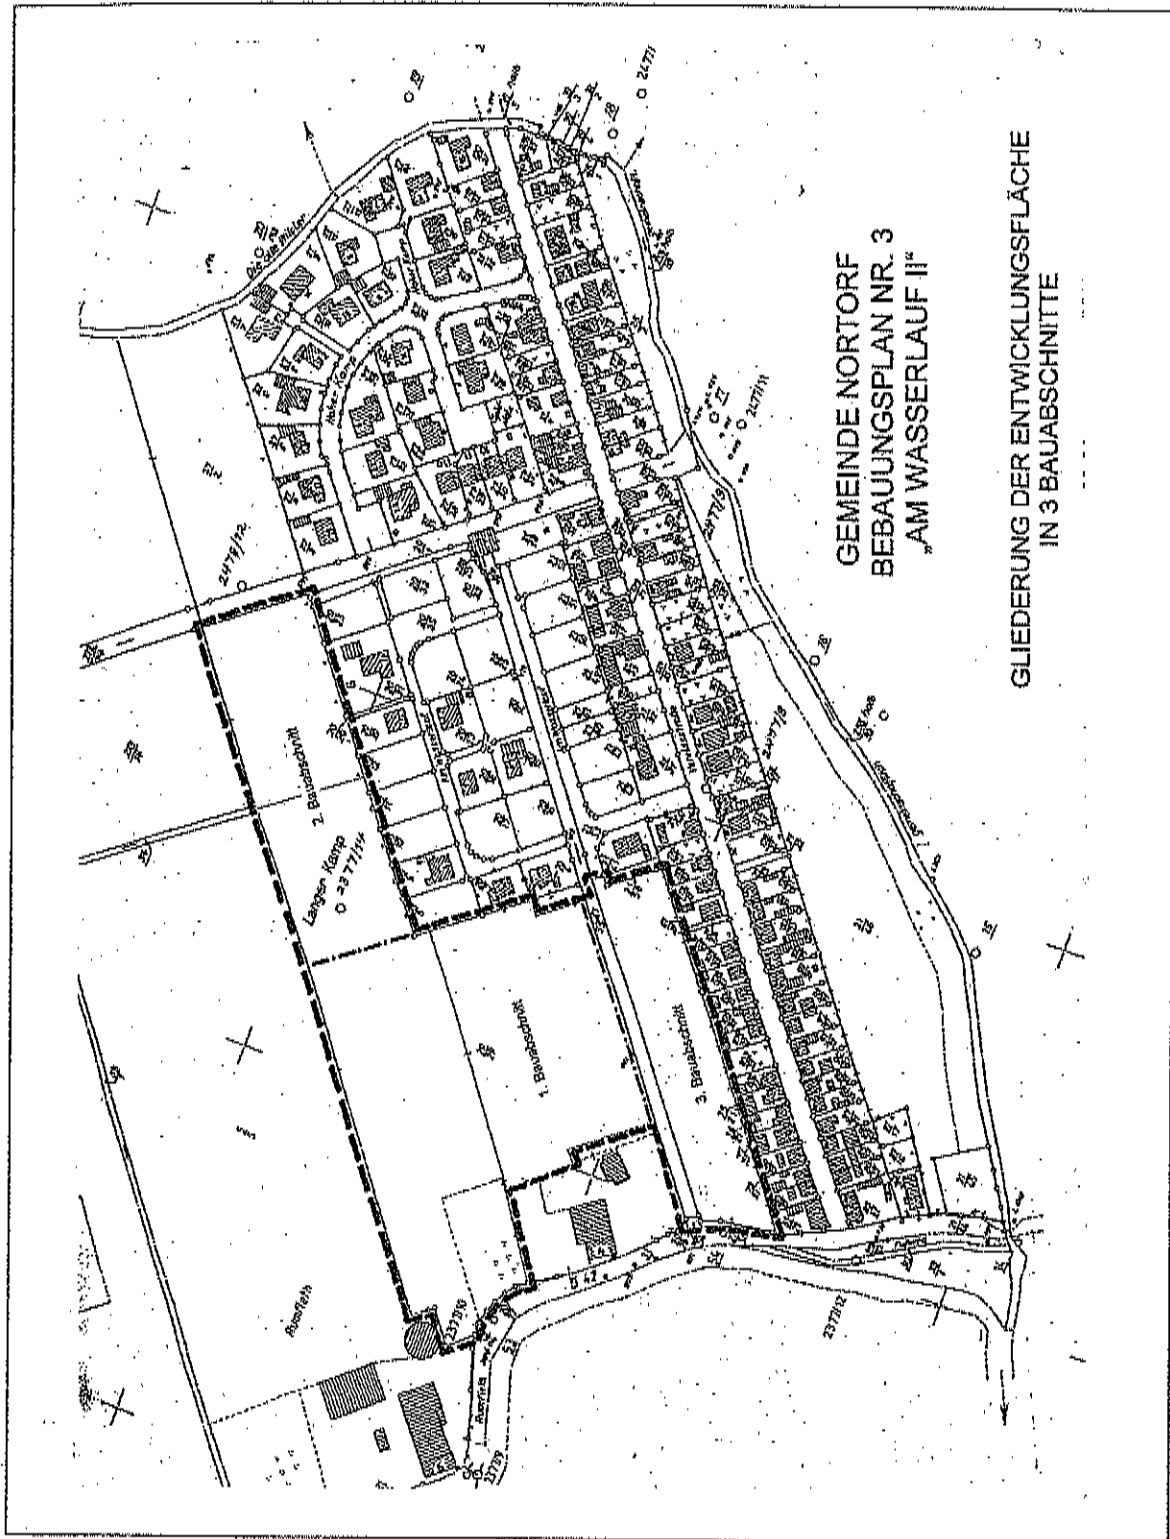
Gliederung der Wohnbauentwicklungsfläche des Bebauungsplanes Nr 3 in 3 Bauabschnitte, Planungsstand vom 05.12.2000, unmaßstäblich
